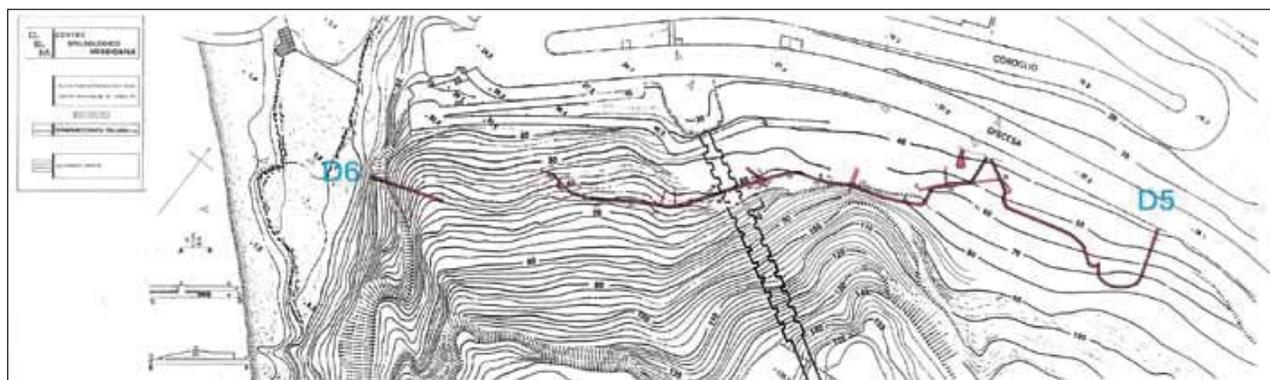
Discesa Coroglio: planimetria delle cavità D5 e D6 (per gentile concessione dell'ing. Clemente Esposito).
